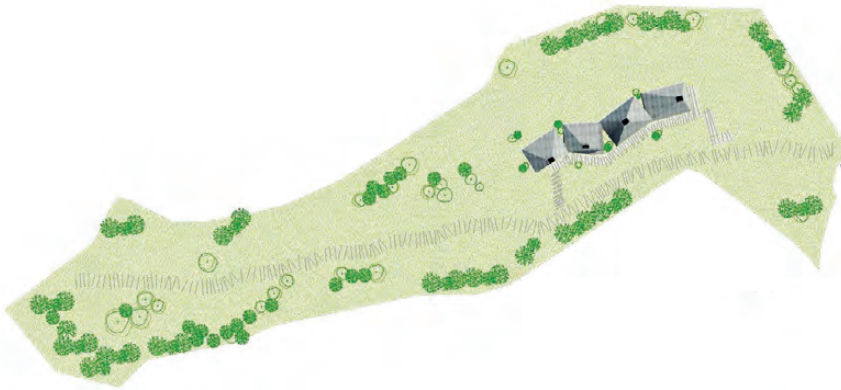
Plano de emplazamiento (2010) / Figure 2. Site plan (2010).
